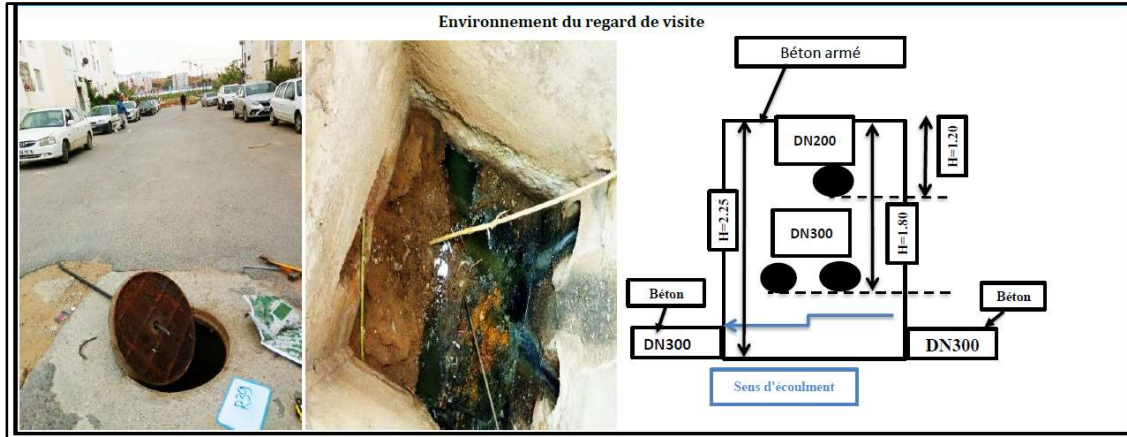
Regard R39 qui dirige les eaux vers SR05 (Source : Bureau d'études AH2E / juin 2020)
